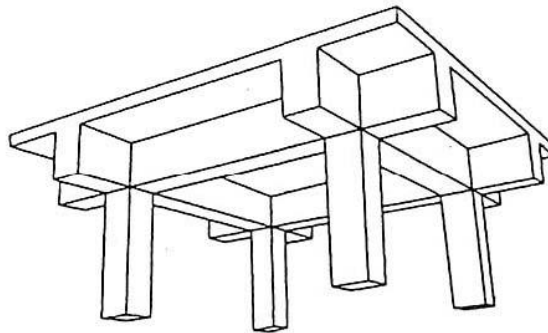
i. Diseño de losa de vigas de canto en dos direcciones. [A3]
